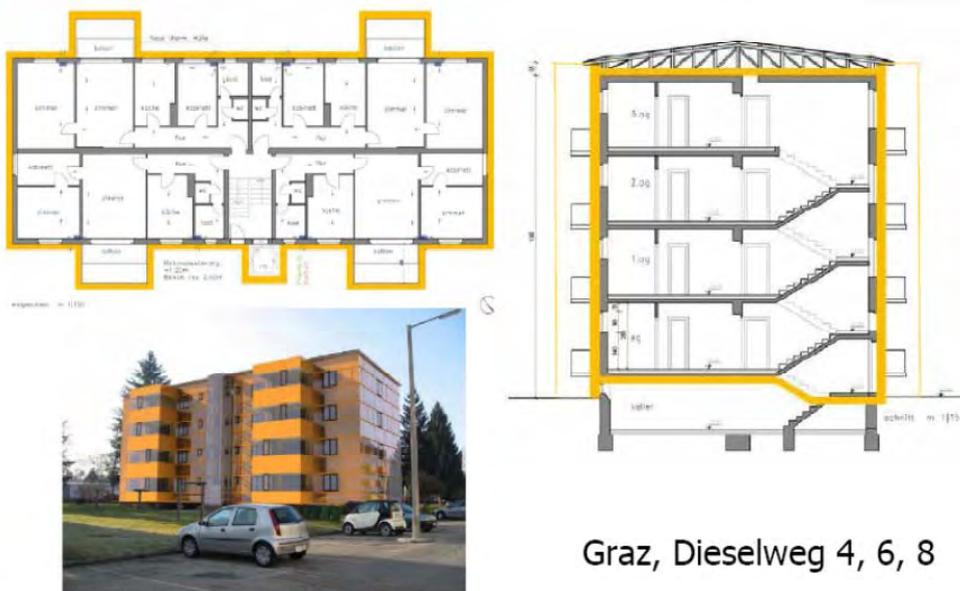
Grundriss (links oben), Schnitt (rechts) und NO-Ansicht des Gebäudes Haus Nr. 4 nach der Sanierung (Quelle: Hohensinn Architektur)
